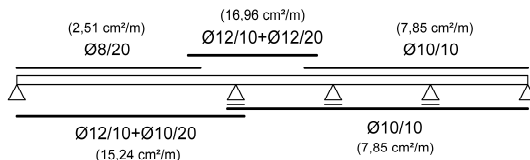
Bewehrungsskizze der erforderlichen Bewehrung zur Begrenzung der Rissbreite bei Überlagerung der Beanspruchungen infolge von Zwang und äußerer Last
